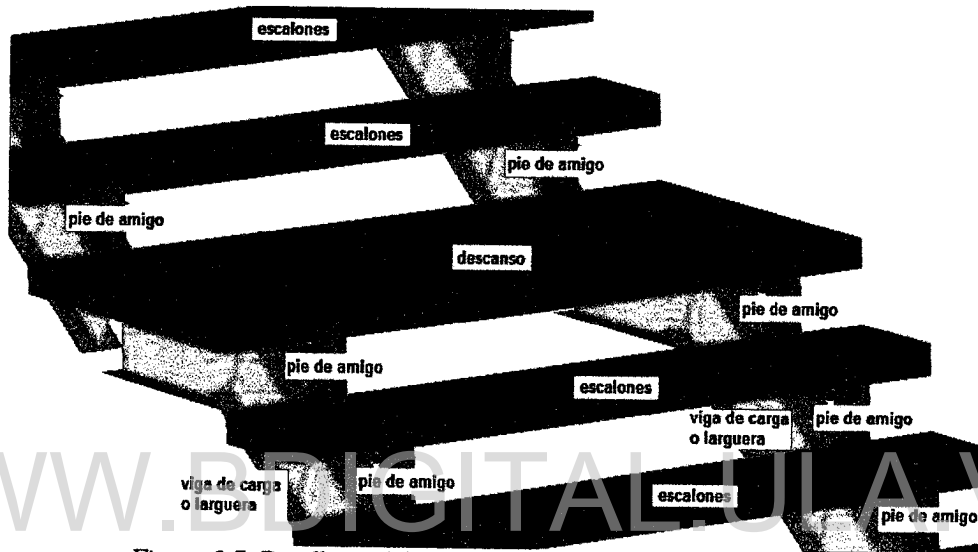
, Detalle modelado de escalera metálica y sus elementos.
